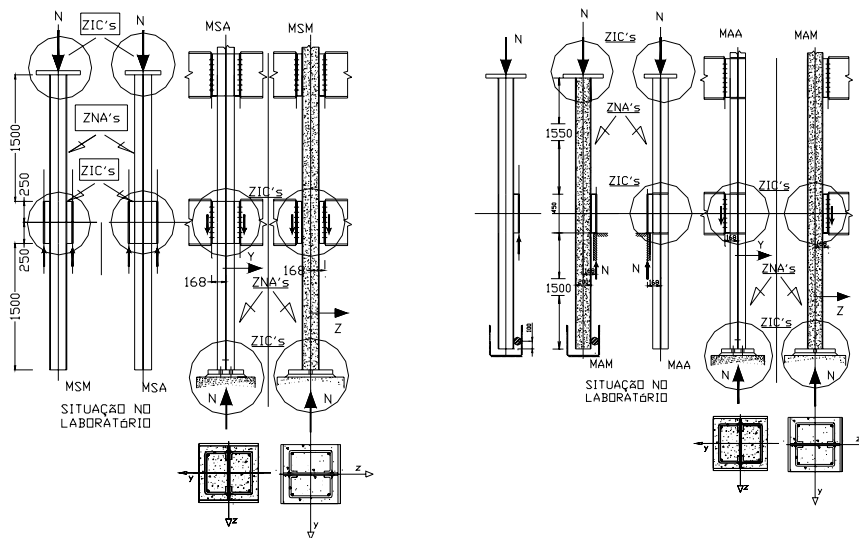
Esquema estático de cálculo e situação no laboratório a) para pilares com ligações centradas, b) para pilares com ligações excêntricas
